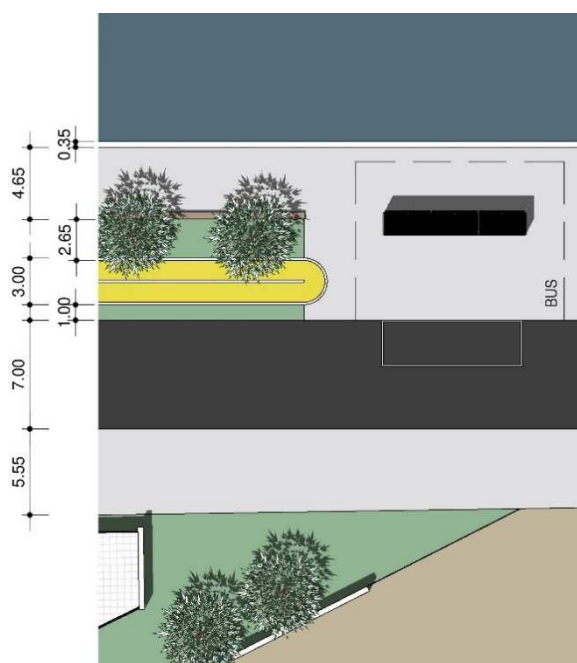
ESQUEMA PERFIL DE RUA PROPOSTO– IMAGEM: AUTOR
